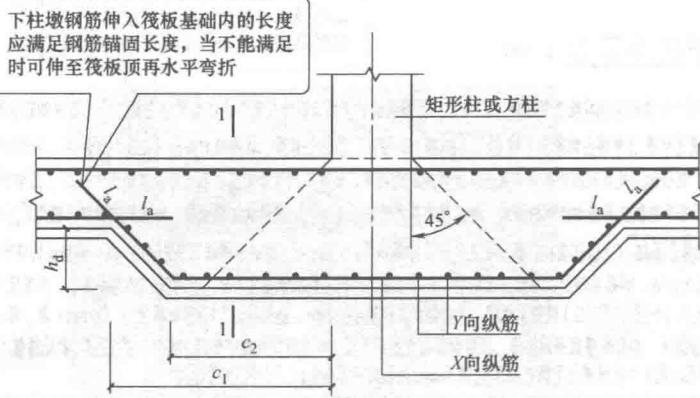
基础下柱墩钢筋构造 (1) 1-1 剖面图
